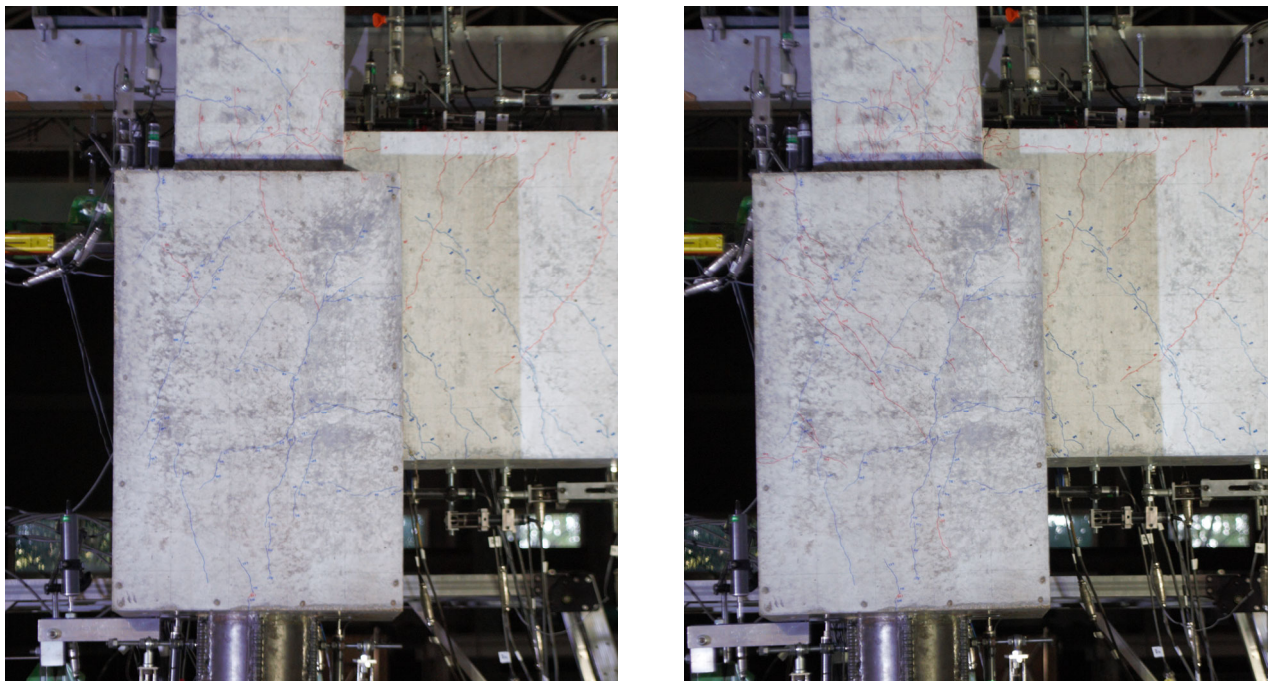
最大耐力時ひび割れ状況 (左 : R=+2.0%、右 : R=-2.0%)
